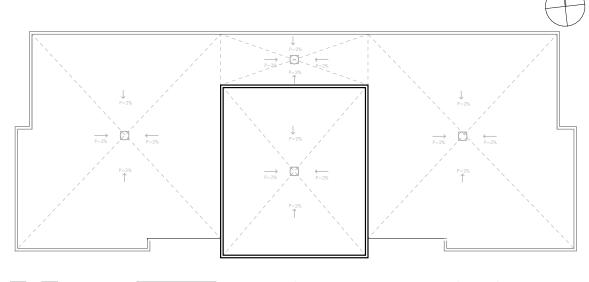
Planta Cubiertas Zona Veterinaria Fuente: Autor
